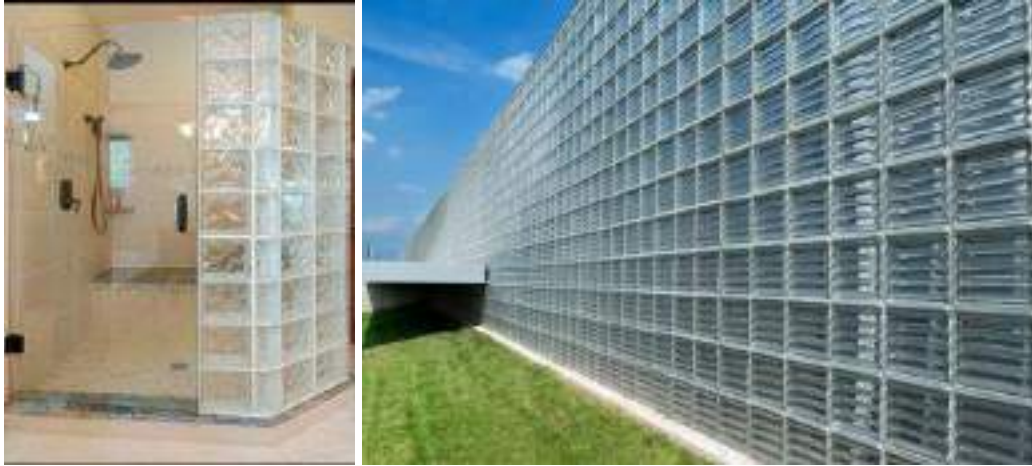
Separador de espacios y fachada exterior con ladrillo de vidrio.
